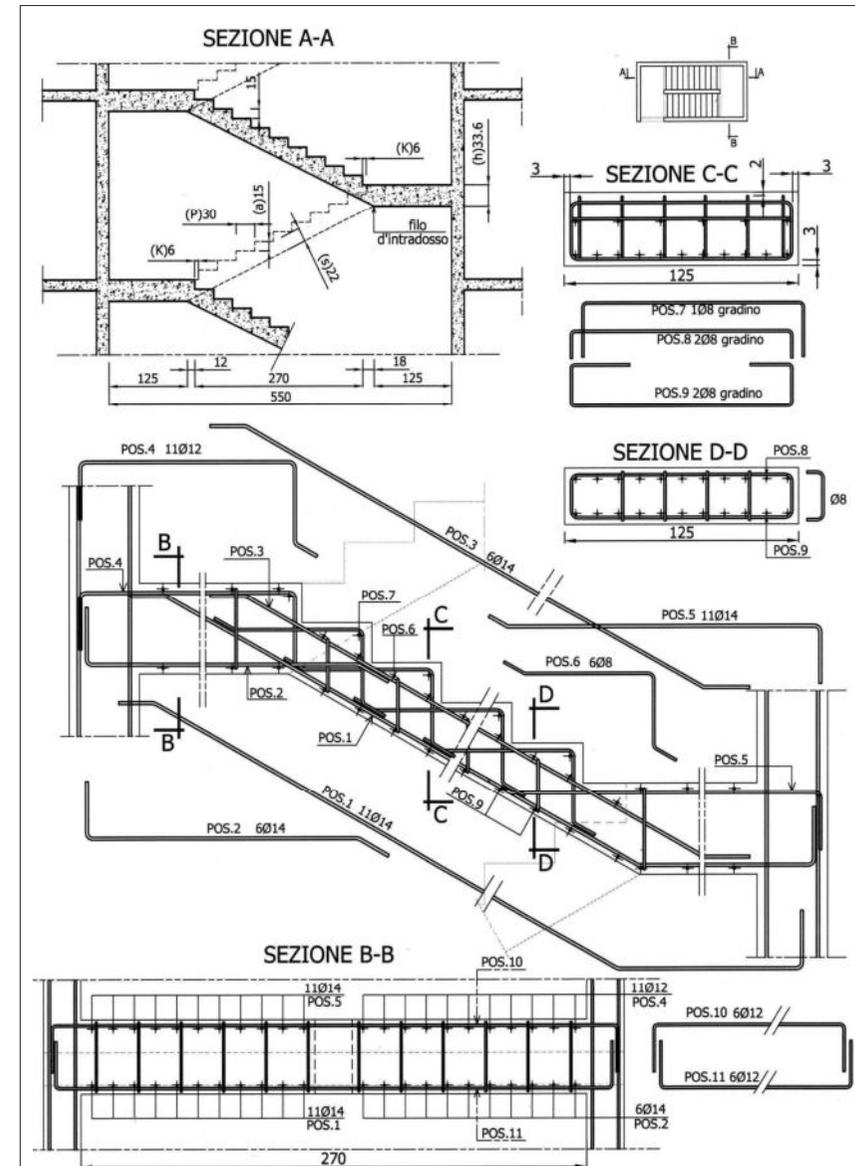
Scale con solette rampanti: schemi di armatura
